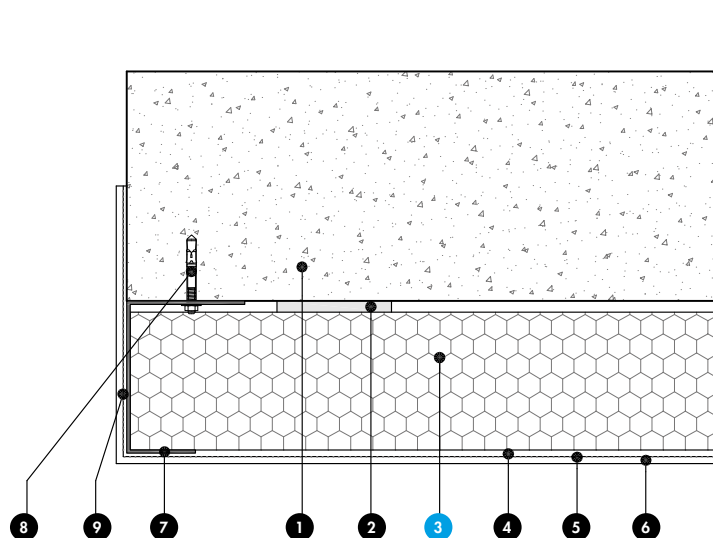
Arrêt latéral d'angle (coupe horizontale)
